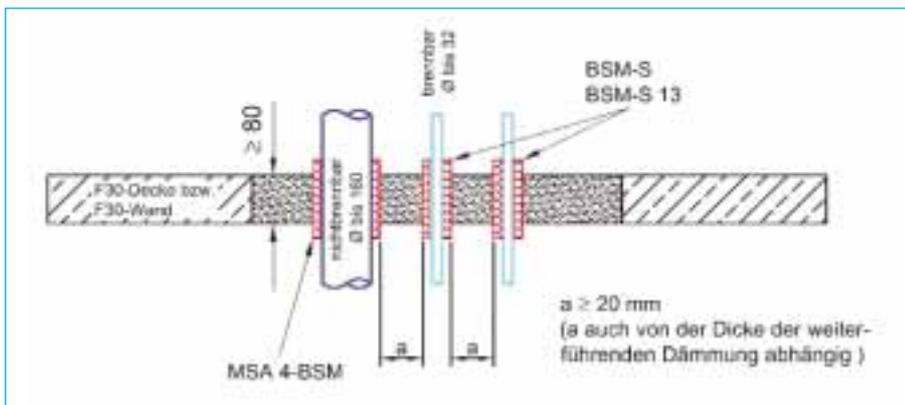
Rohrdurchführungen durch F30-Wände bzw. F30-Decken
